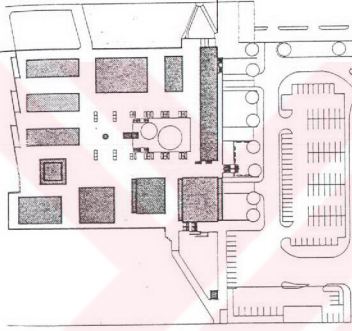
Quincy Market planı ve görünüşü. (N.Beddington, Design for Shopping Cent.)
